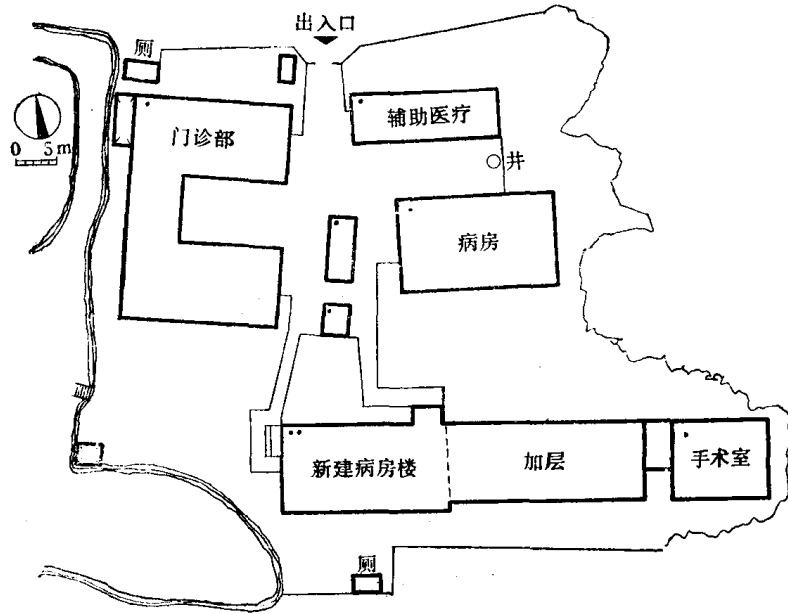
上海奉城医院总平面图 (250床, 300人次)
